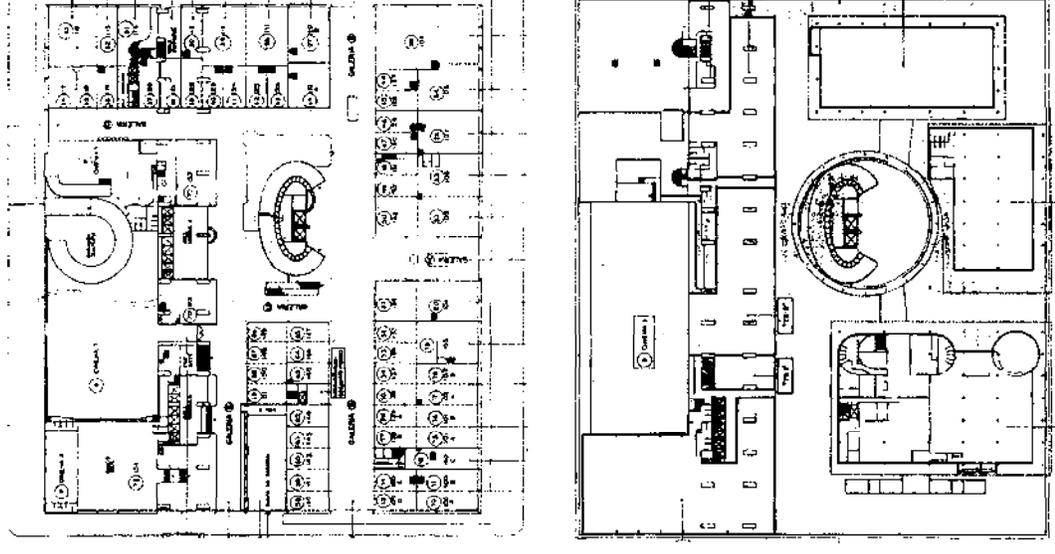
Planta térrea e Planta de cobertura, que remetem a morfologias distintas do edifício Conjunto Nacional.
